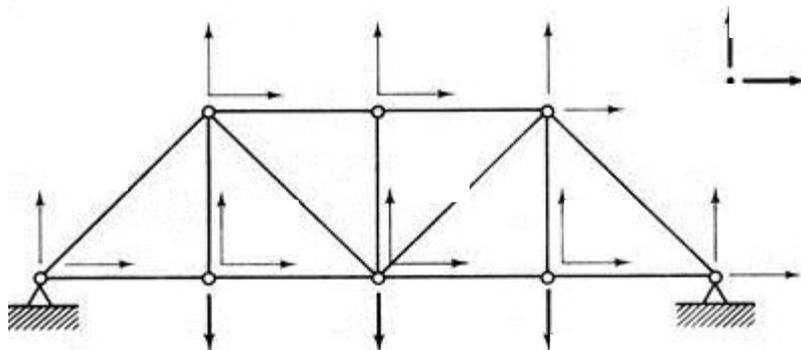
Reticulado Plano (Chandrupatla and Belegundu, 1999)
